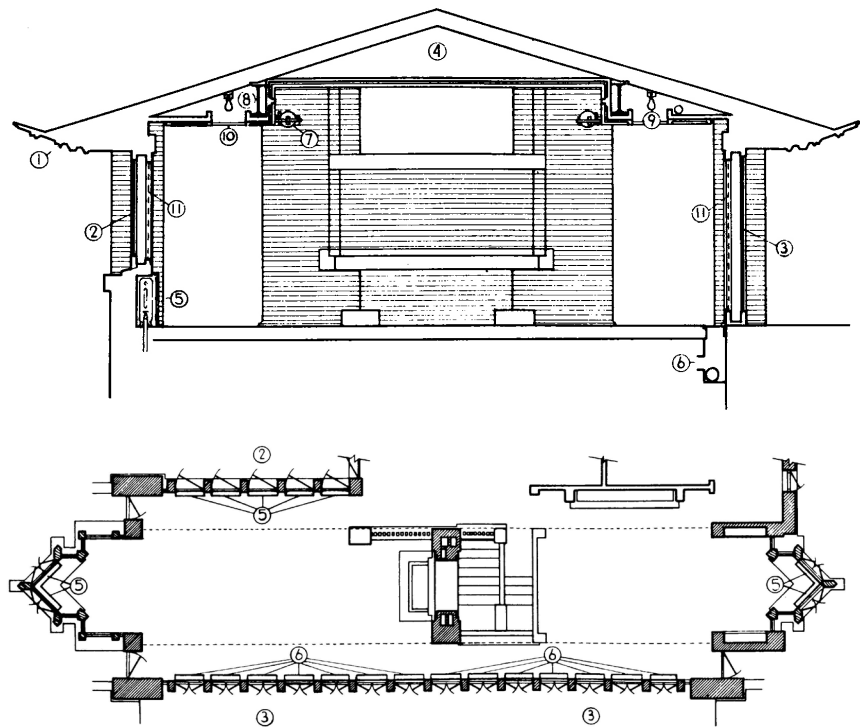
e 26: Secção e planta parcial do segundo andar (sem escala), com as instalações indicadas e legendadas:
